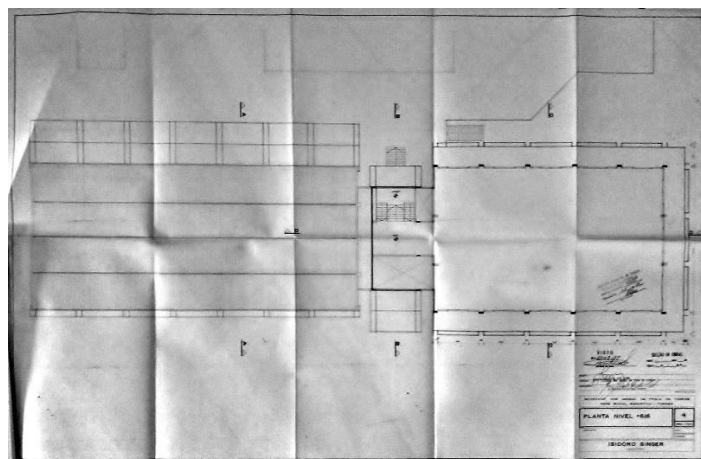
Planta baixa nível +315. Projeto executivo de 1979. Arquiteto Isidoro Singer
